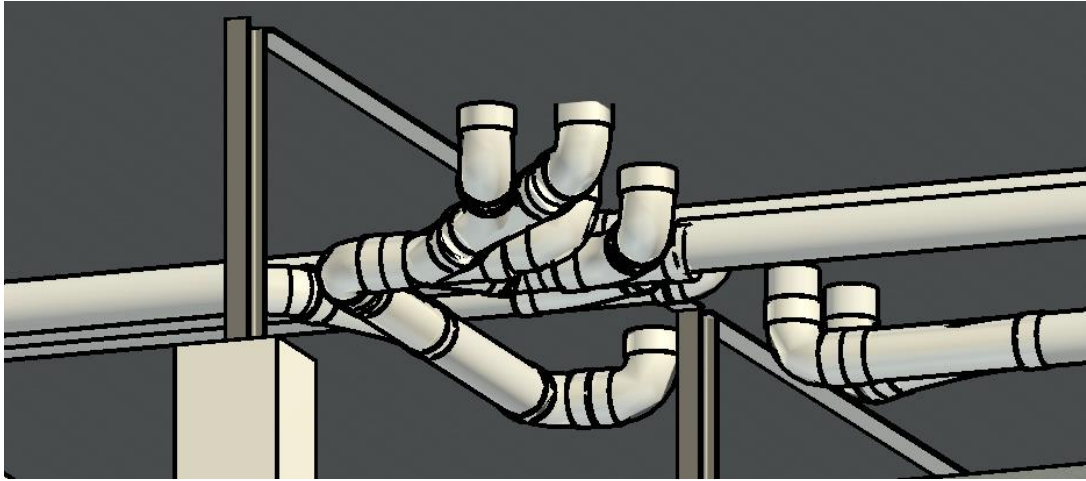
Modelizado de las tuberías del Garaje Fuente: Elaboración Propia.
